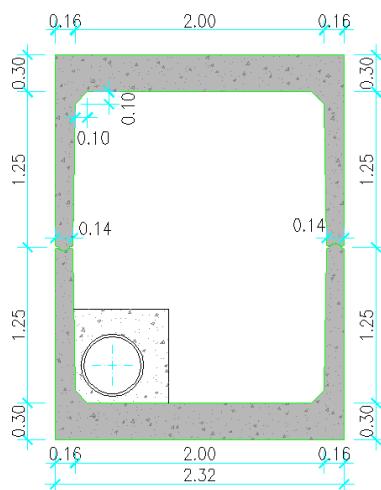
Corte Transversal da PH na zona da Box-culvert
